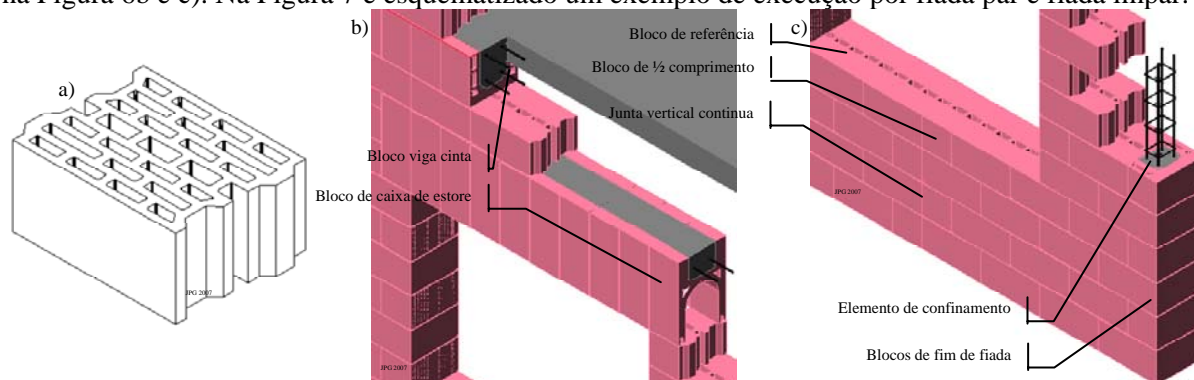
Esquemas: a) blocos 400×200×320; b) Pormenor de execução de vigas; e c) Pormenor de execução de elementos de montante em bloco do sistema construtivo para o efeito.
